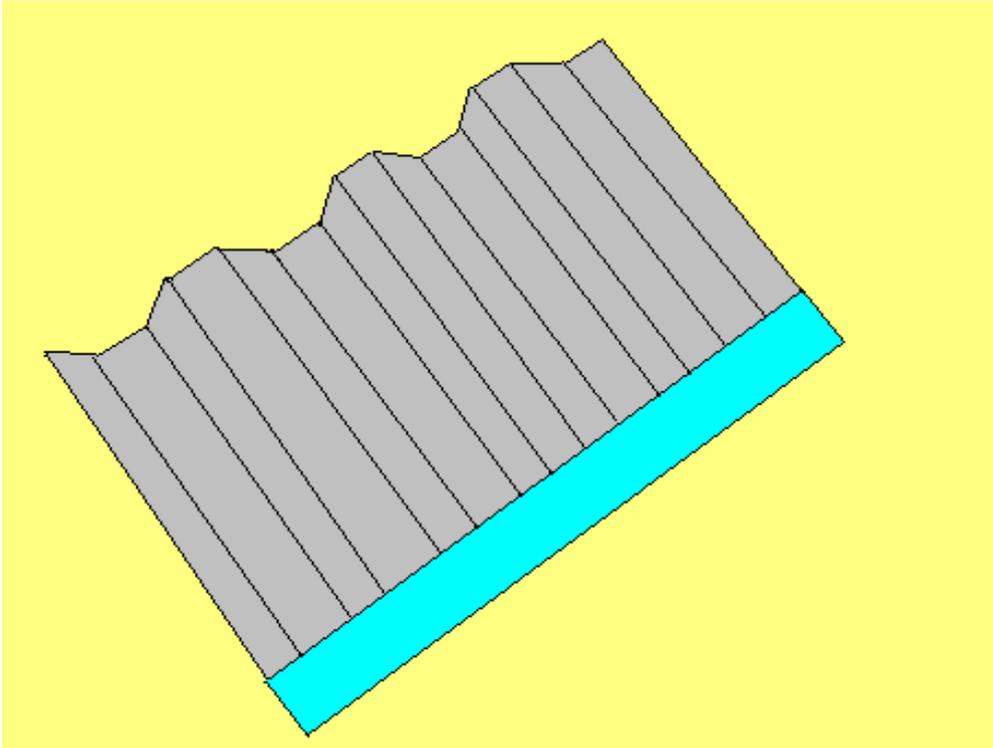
Panel corrugado con plancha de plástico sellada con silicona.
